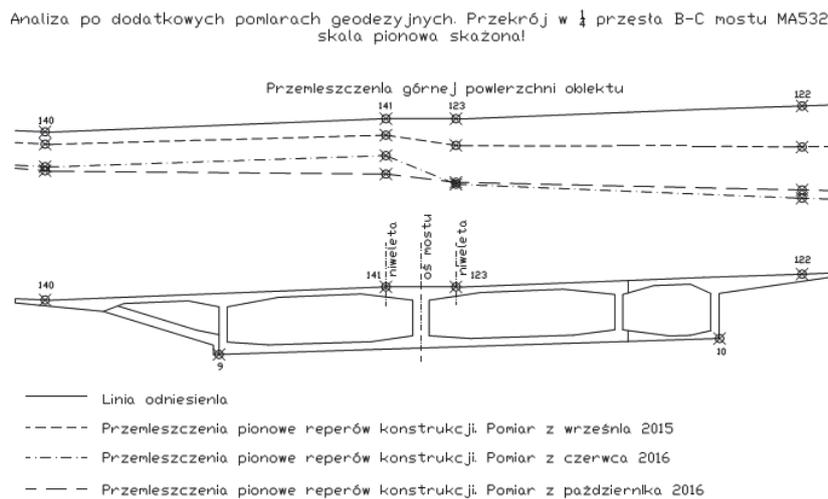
Porównanie pionowych przemieszczeń w przekroju 1/4 przęsła B-C
